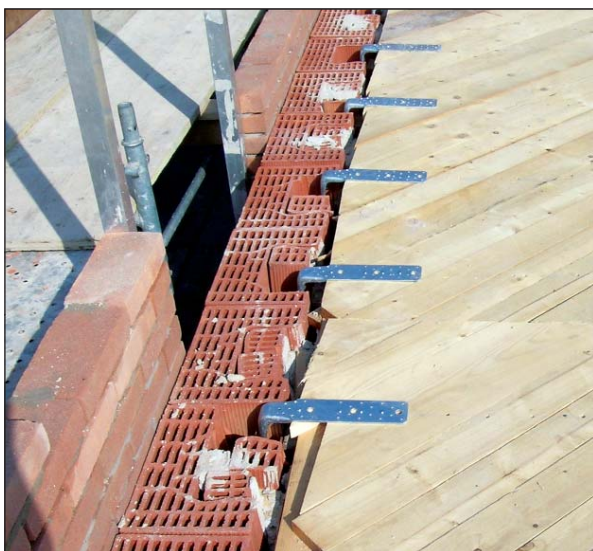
Struttura portante verticale perimetrale in blocchi di laterizio alveolato associato a mattone a vista: ancoraggio alla muratura di doppio assito incrociato su struttura orizzontale lignea.
